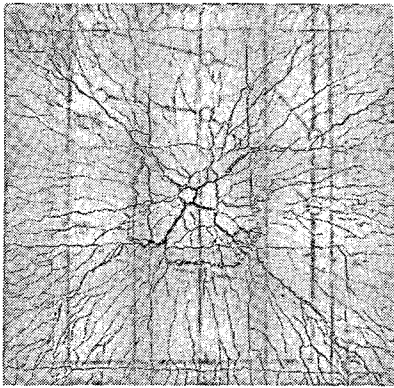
鋼繊維補強鉄筋コンクリート2方向床版のひびわれ状態 (鉄筋ピッチ 30 cm,  $V_f=1.5\%$ )
